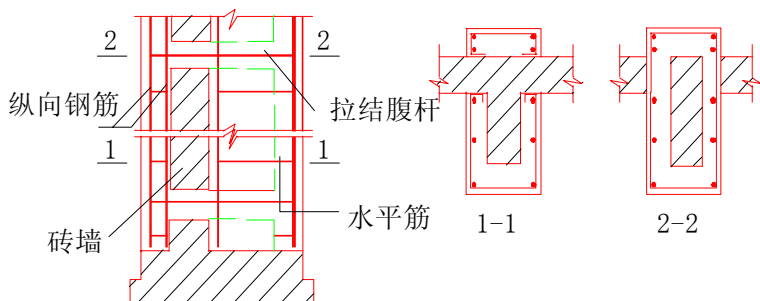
钢筋混凝土外套加固砖柱(墙垛)
